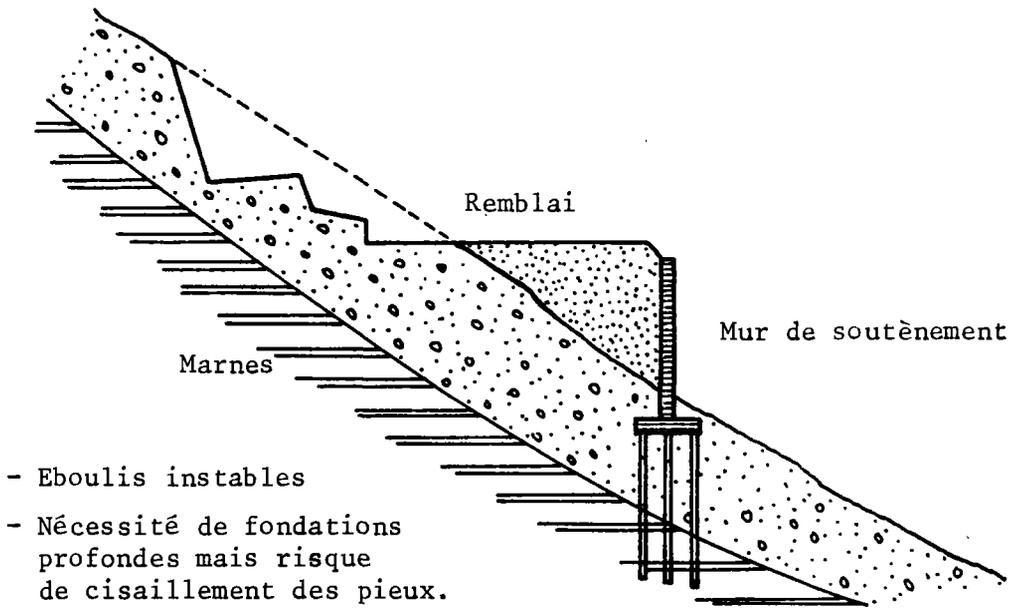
Stabilité d'un mur en terre armée sur une pente
